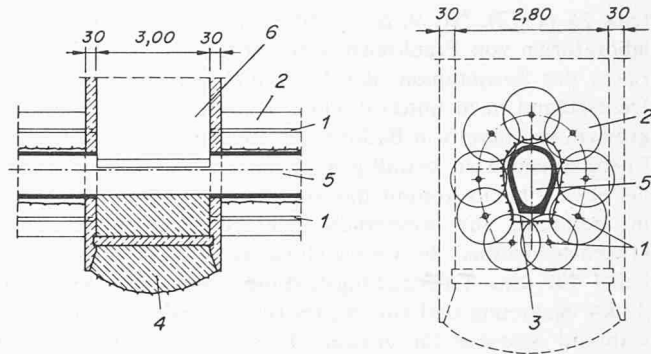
Erstellung eines Schmutzwassersiells mit Hilfe des Gefrierverfahrens in Hamburg. Schema der Gefrierrohranordnung. 1 Gefrierlanzen, 2 Frostmantel, 3 Magerbeton, 4 Beton, 5 Eiprofil 70/105, 6 Stahlbetonschacht  $3,4 \times 3,6$  m (Quelle: Burkhardt, R. «Baumaschine und Bautechnik» 14 [1967], H. 12, S. 1-4)
